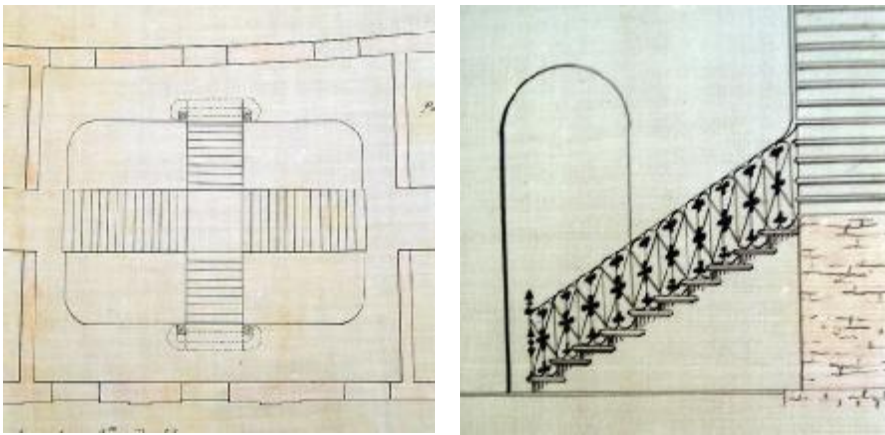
y 9.- Detalle de planta de la escalera y alzado.
